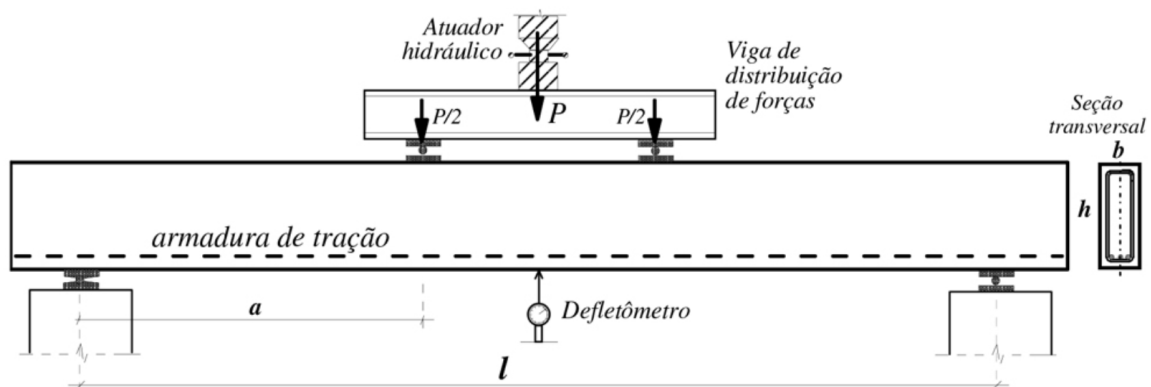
Esquema de ensaio à flexão de viga de betão armado (Teatini, 2016).
